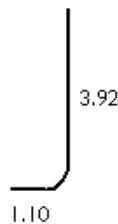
Détail du ferrailage longitudinal du rideau (face intérieure).
